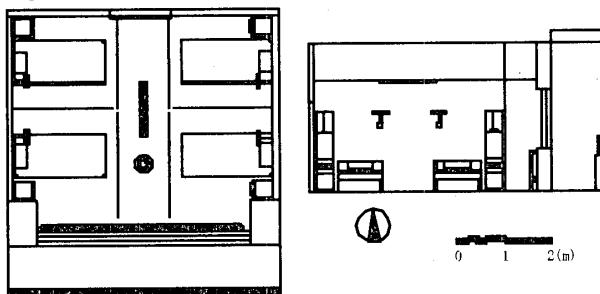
帯広協会病院測定病室の平面図(左)と断面図(右)
